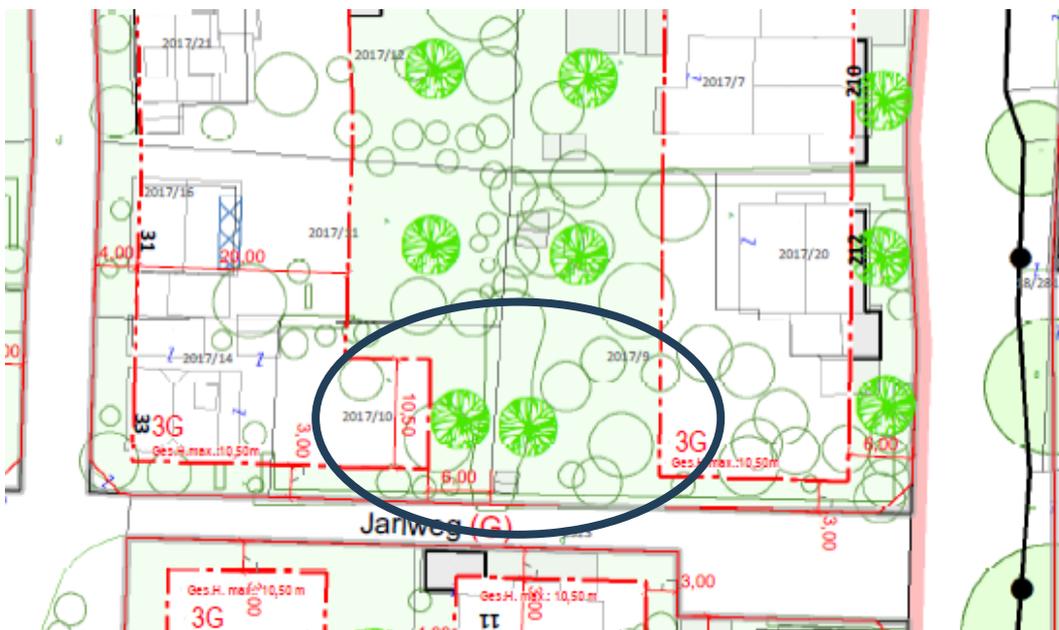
17.24.0 Bebauungsplan – Beschluss: Ausschnitt des Bereiches der Änderung
